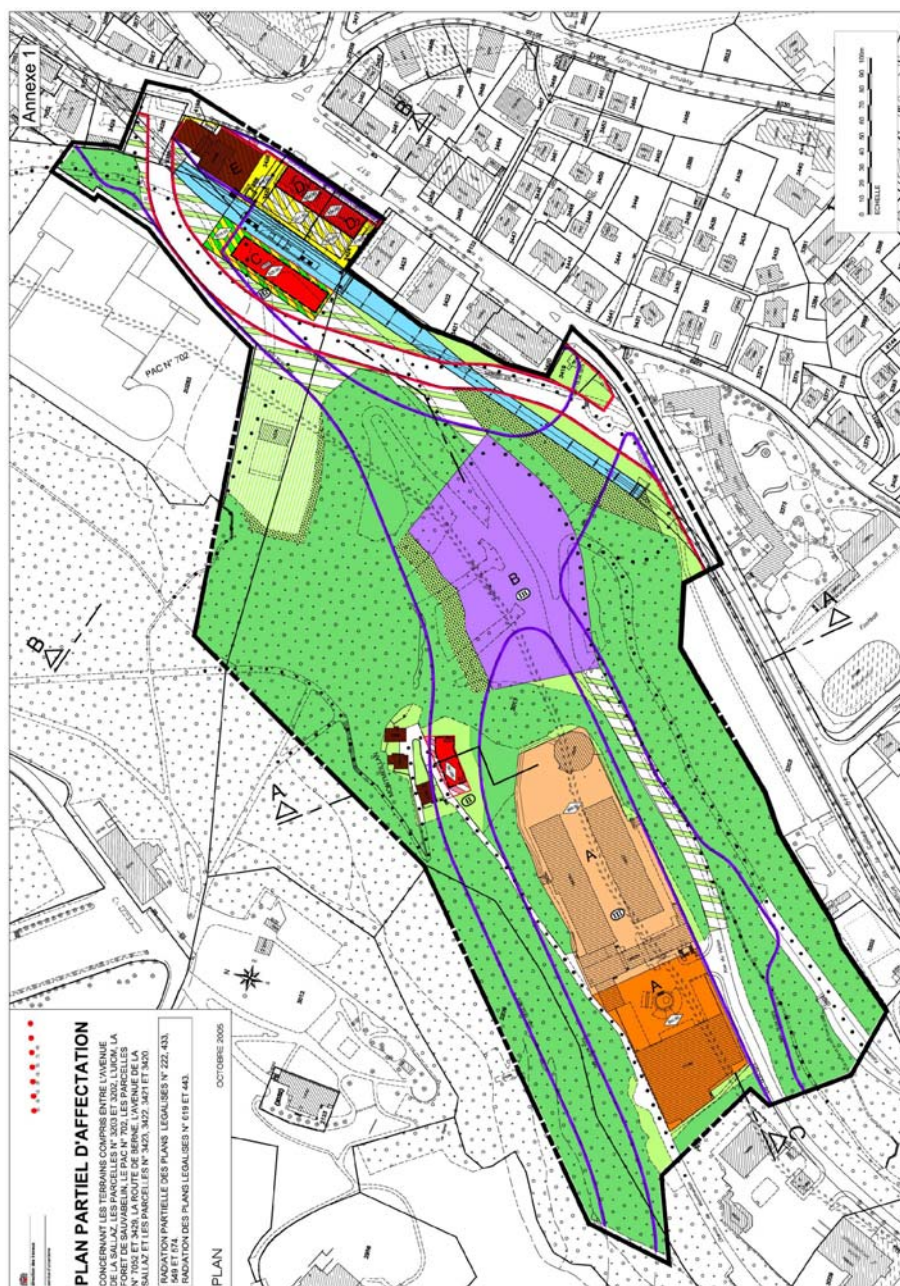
Plan route de contournement de la Sallaz, situation générale
